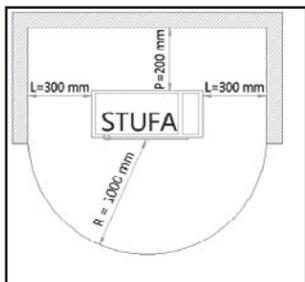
A: Distanza di sicurezza intorno alla stufe in caso di montaggio a pavimento
